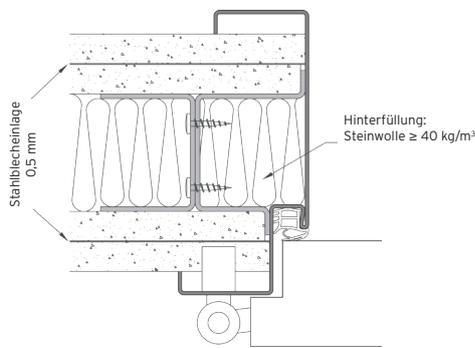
RC2-System, einbruchhemmender Wandaufbau für Stahlumfassungszarge (optional mit EI_{2,30})
